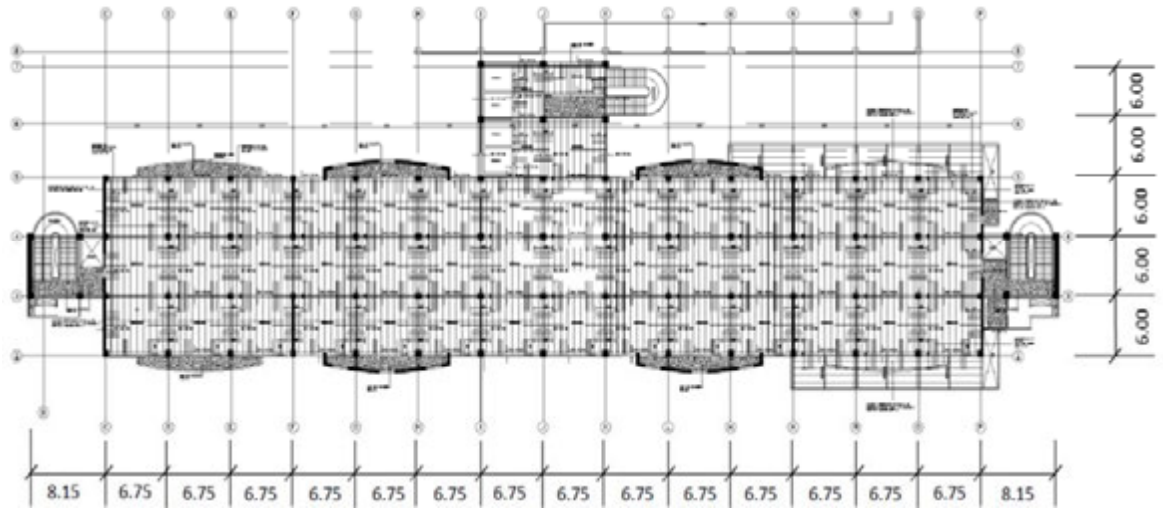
Planta estructural de cuarto nivel, módulo E
